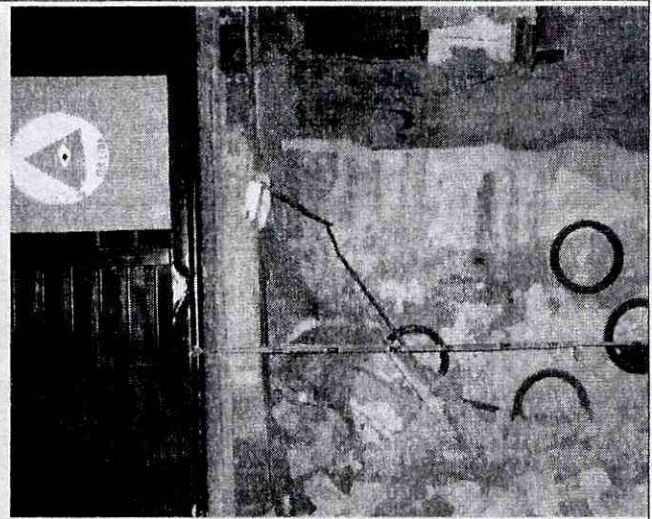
Vista del muro perteneciente de acuerdo a la inspección visual a los linderos del predio de la carrera 1 # 22-76, parte inferior del muro en adobe que colapso del predio de la carrera 1 # 22-82.
